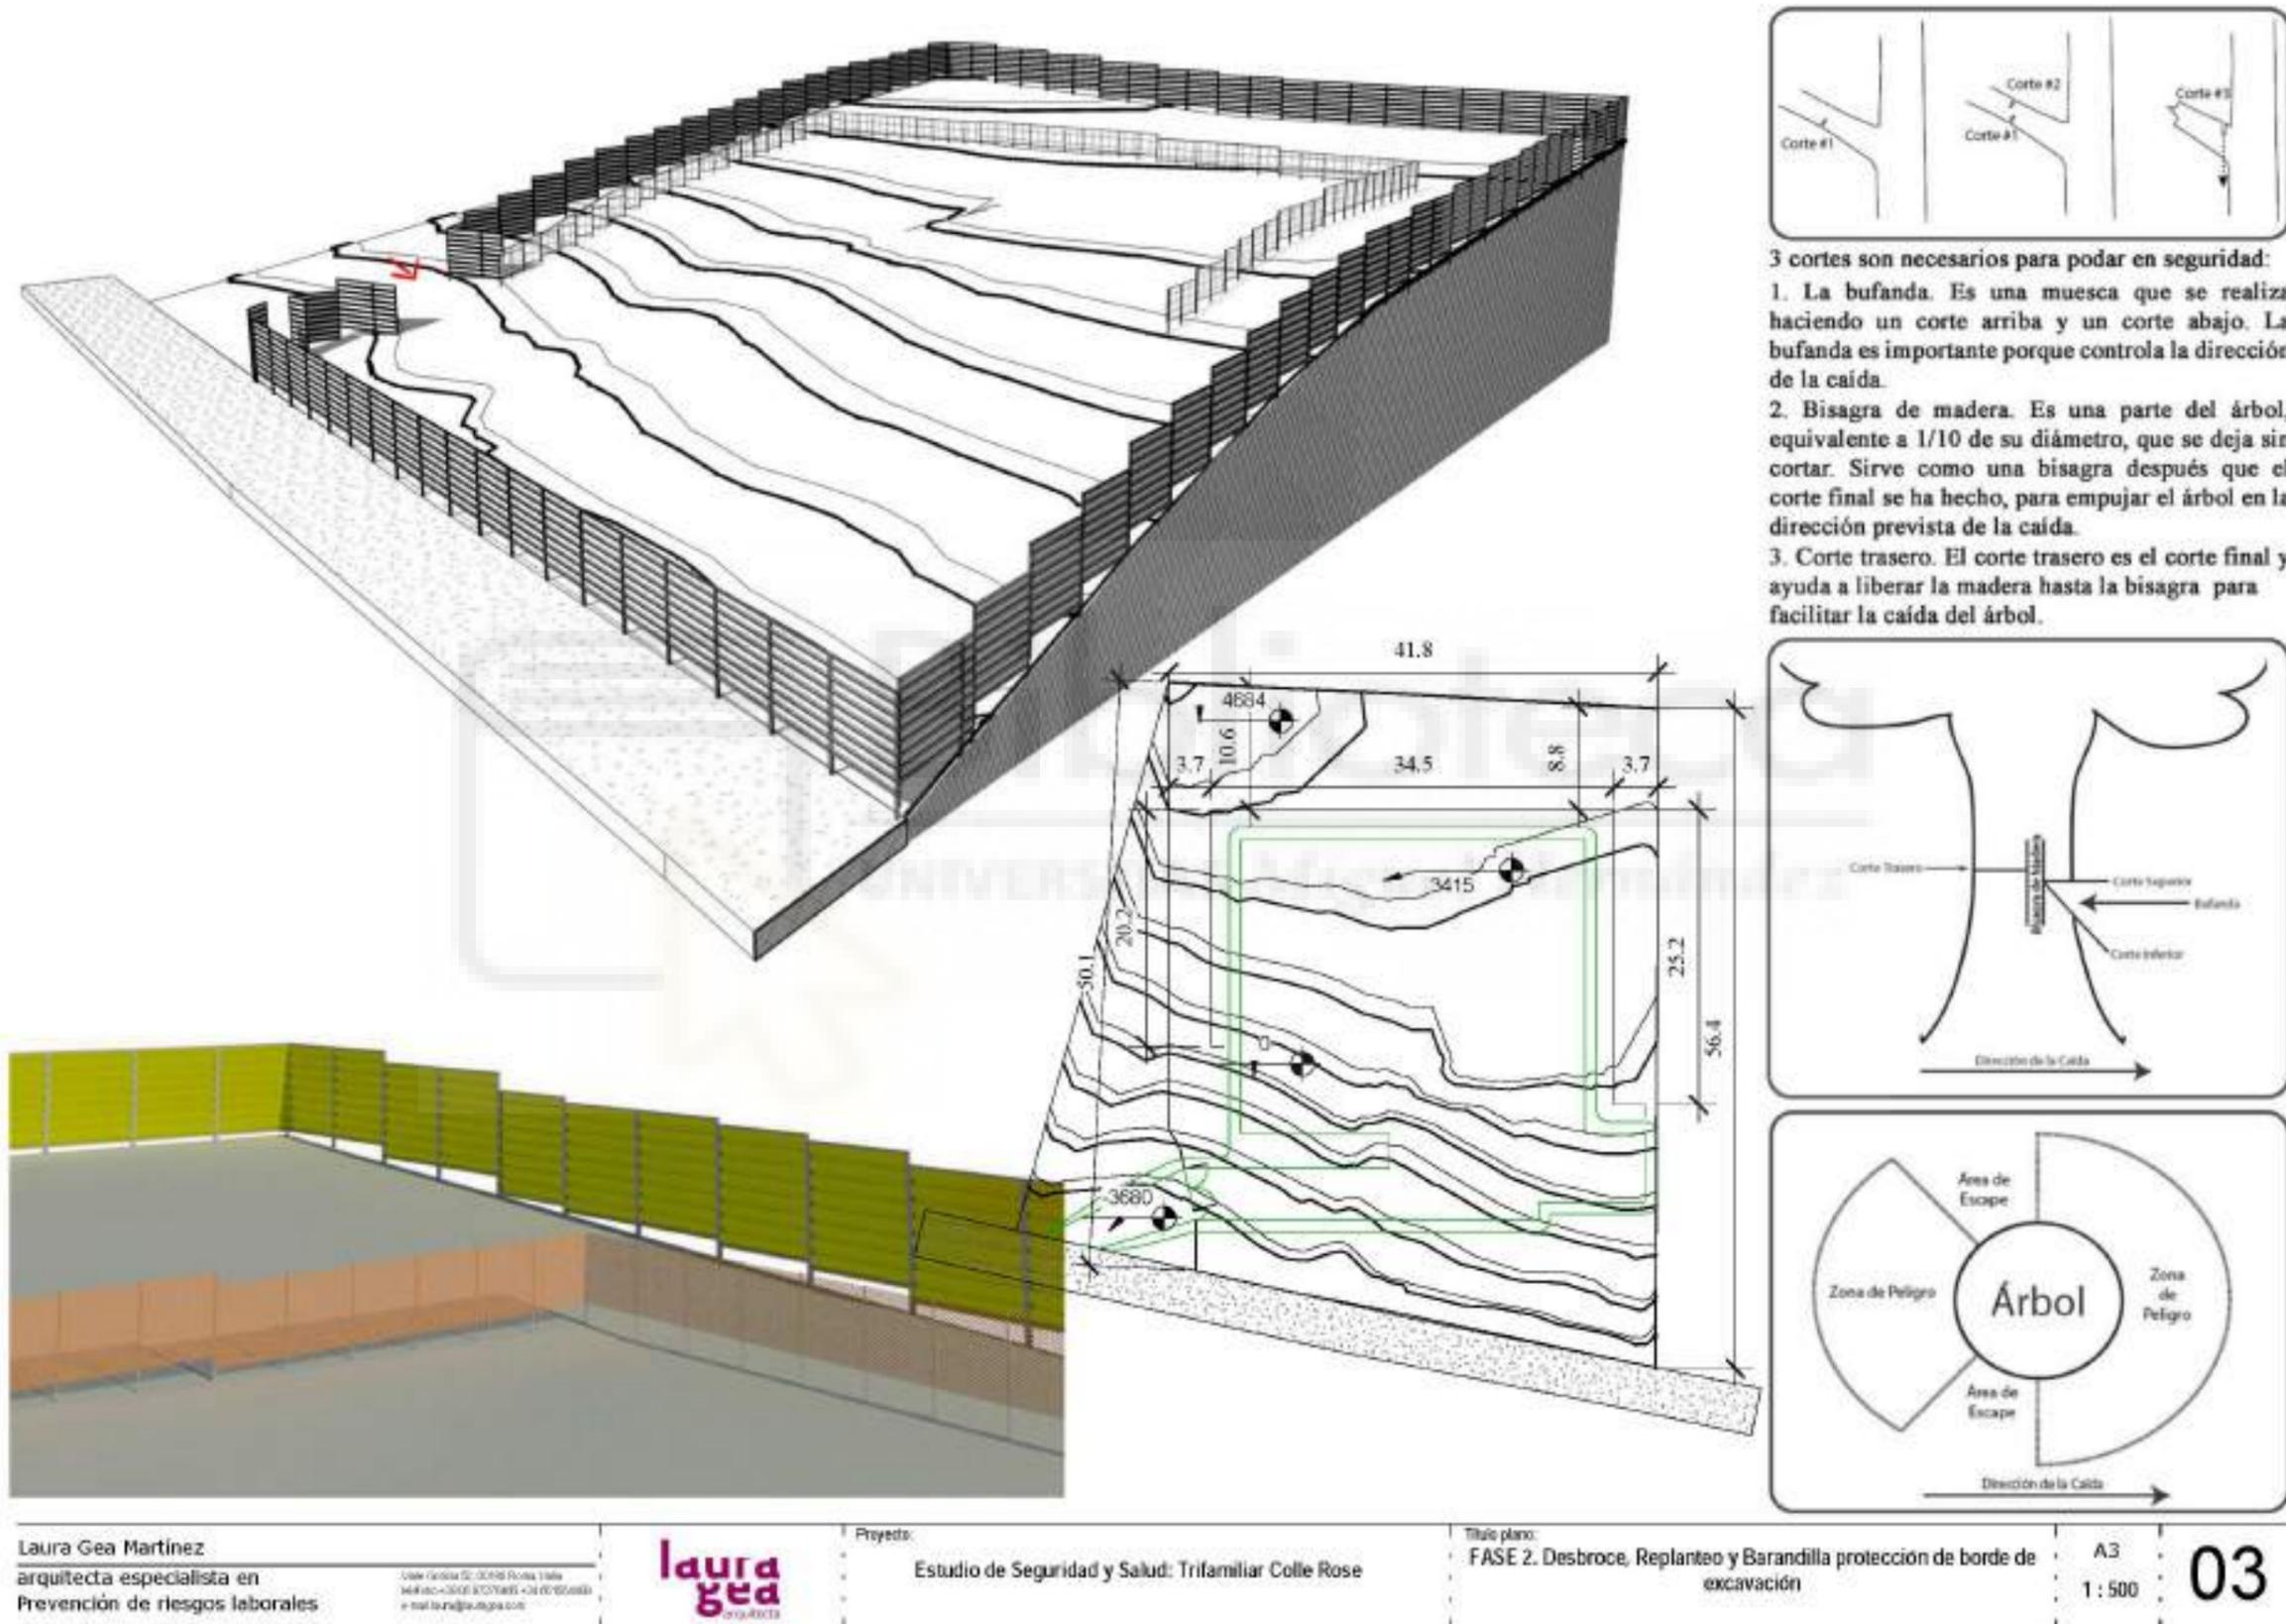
Plano 3, desbroce, replanteo y barandilla de protección de borde de excavación. Fuente: elaboración propia.
